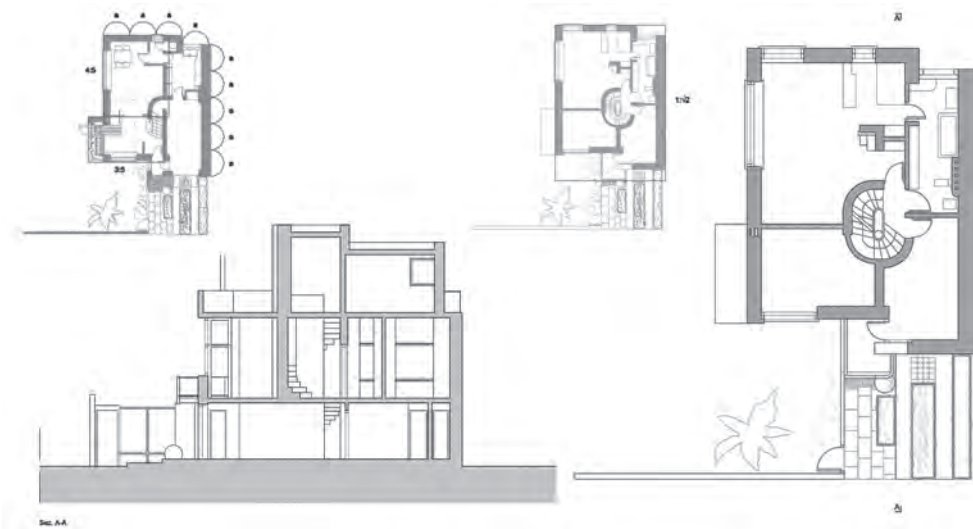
Ridisegno della pianta del primo piano, sezione longitudinale e rapporti armonici.
